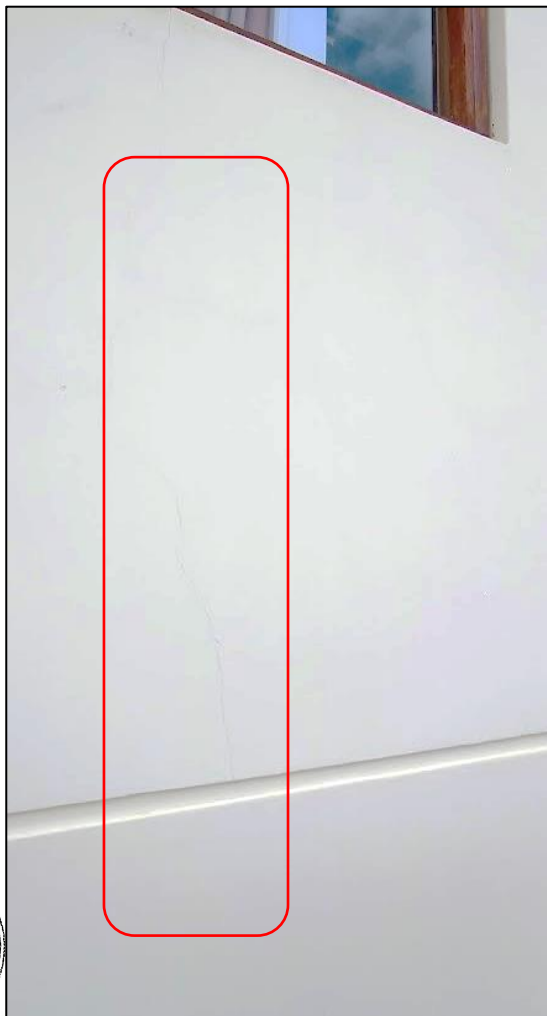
Vista de fisura vertical en muro de fachada oeste.
